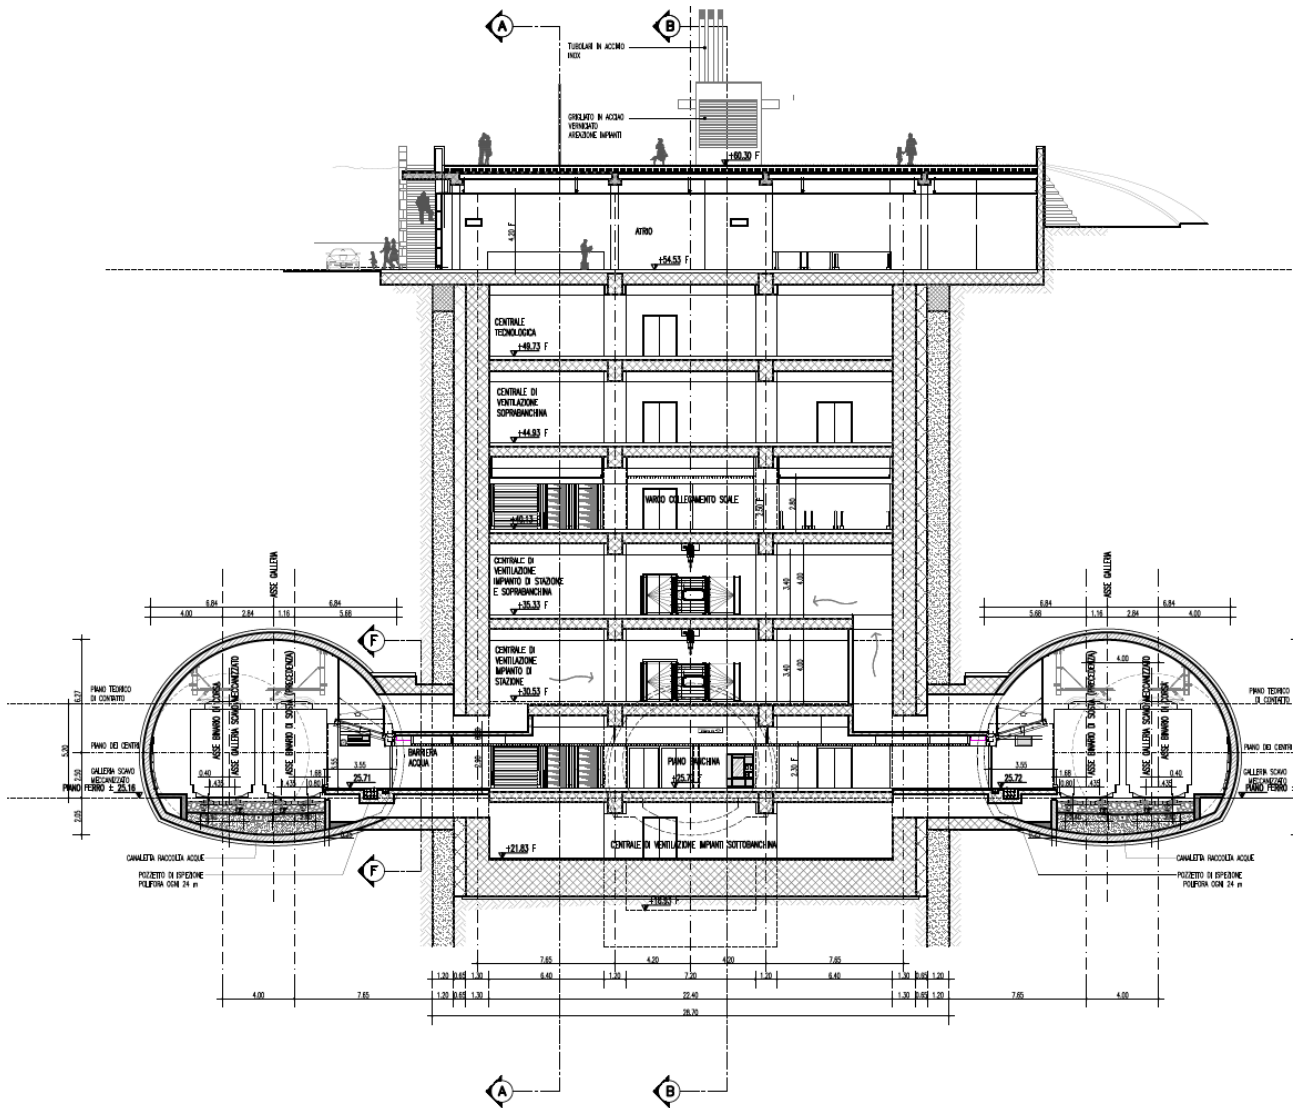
Sezione trasversale Stazione Papardo (rif. elab. ST0088)
